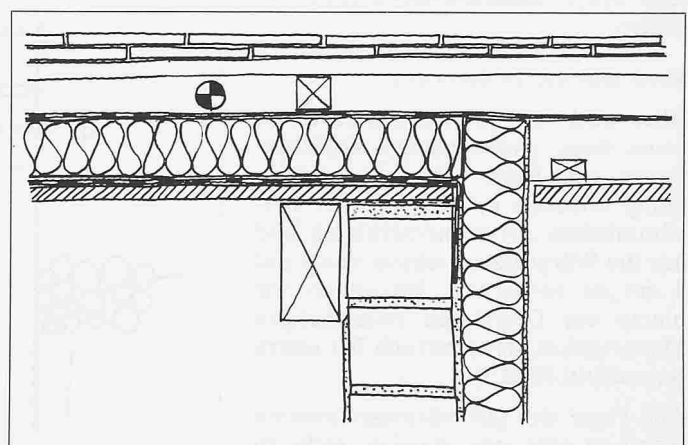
Geneigte «Warm-Kalt»-Dach-Konstruktion. Ort-Detail
